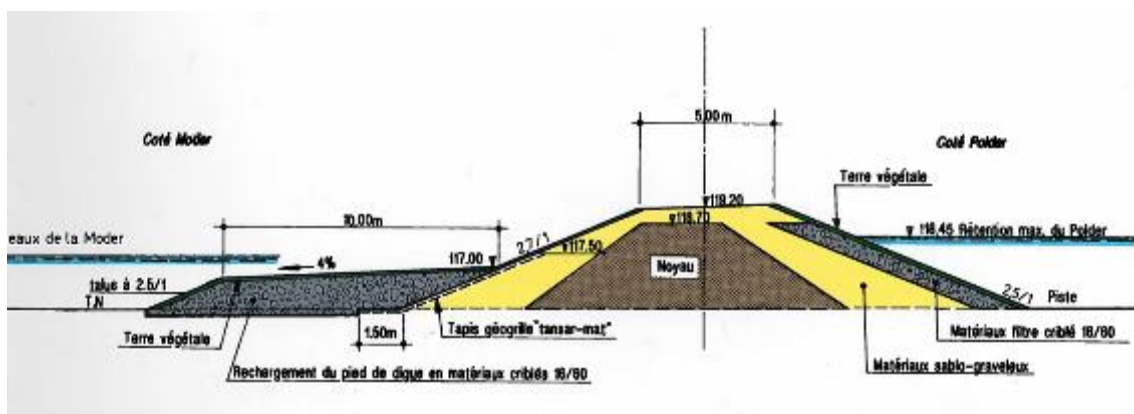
Coupe type de la digue ceinture sur les faces Ouest et Nord
